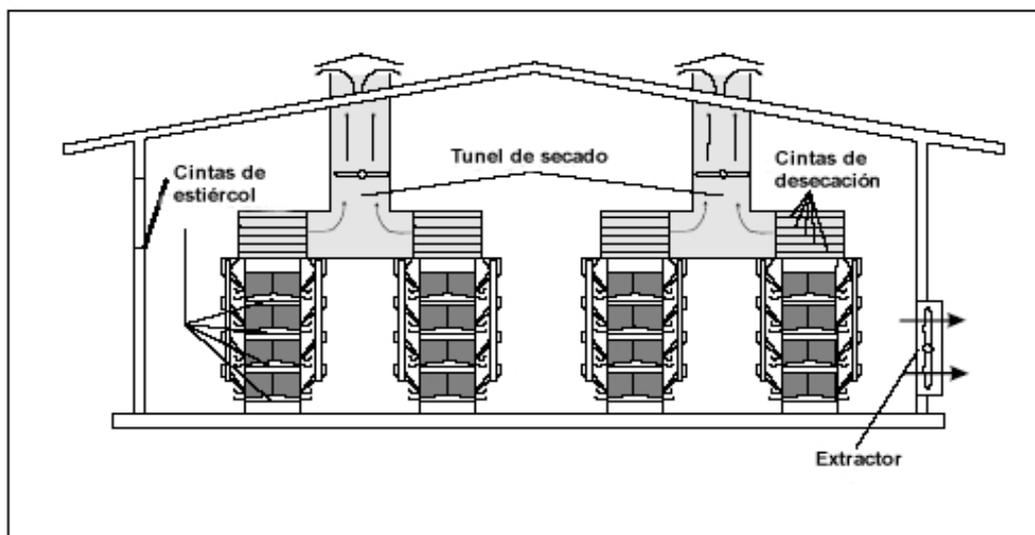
Esquema de un túnel de secado sobre jaulas apiladas verticalmente
